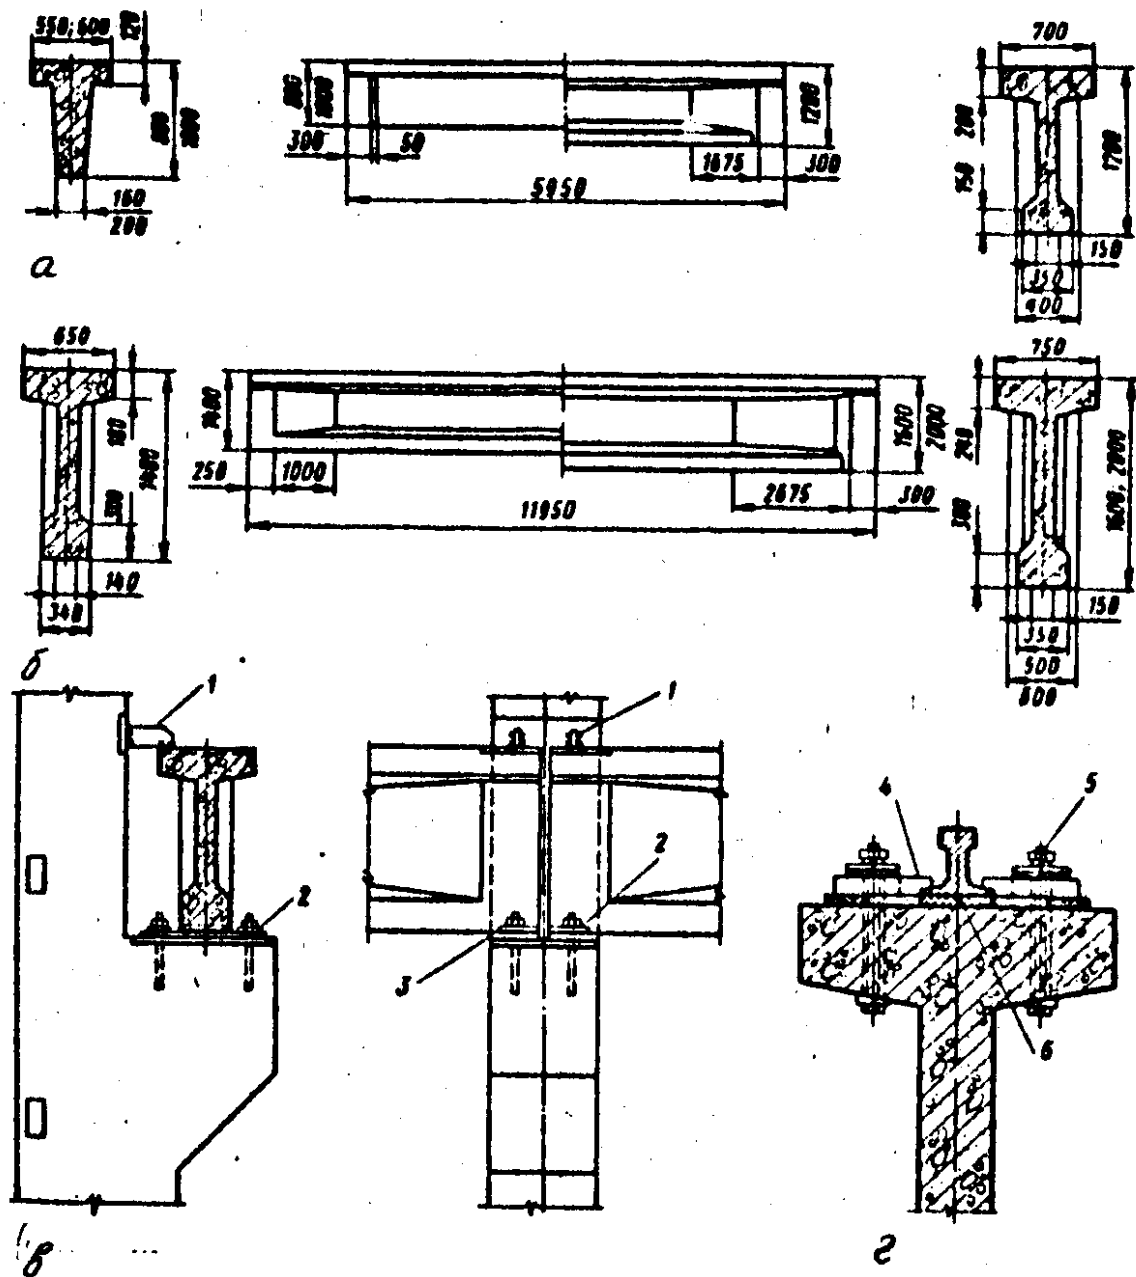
Схеми залізобетонних підкранових балок:
